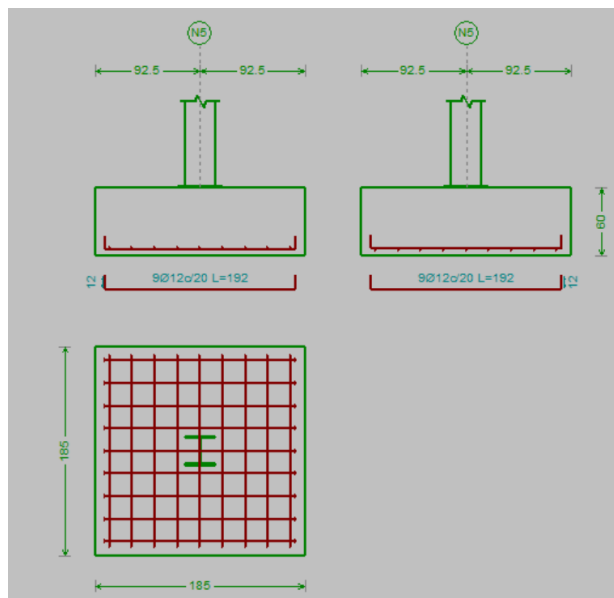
Vistas de la zapata analizada. Fuente: CYPE 3D.
